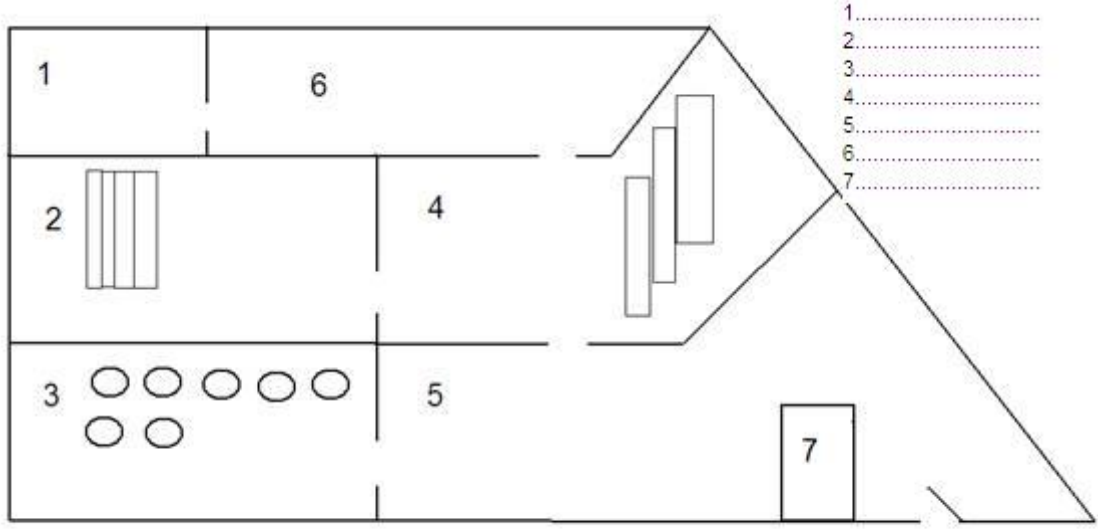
Genel Vaziyet Planı (Örnektir)
